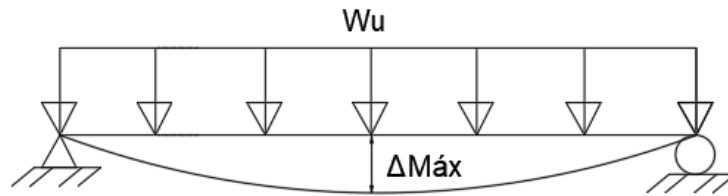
Deflexión máxima de la viga en concreto reforzado.
